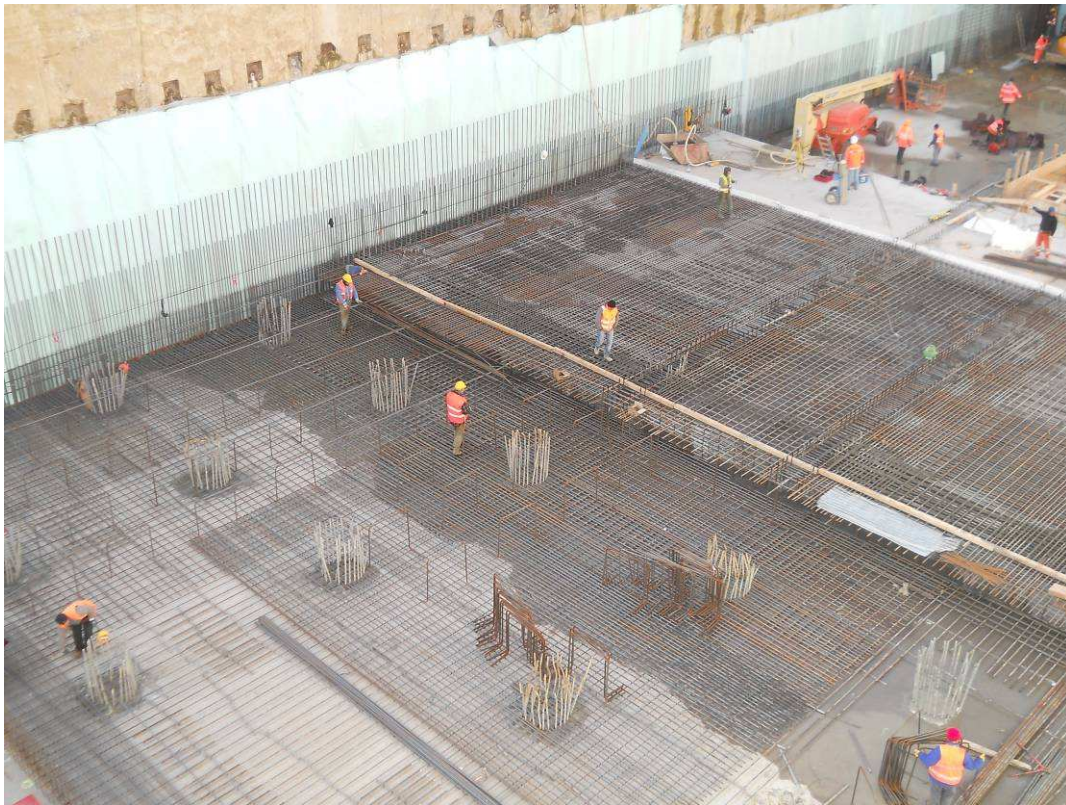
Pozzo lancio fresse – realizzazione soletta di fondazione
